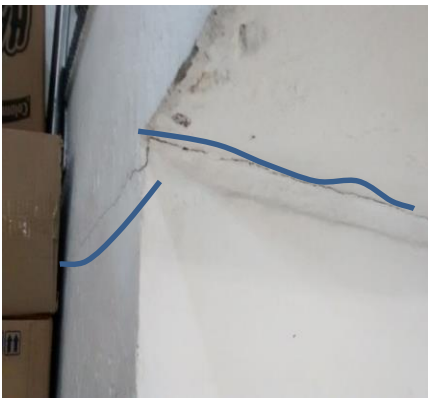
Grietas Horizontales en conexiones con la placa en San Andresito Centro Bucaramanga,
